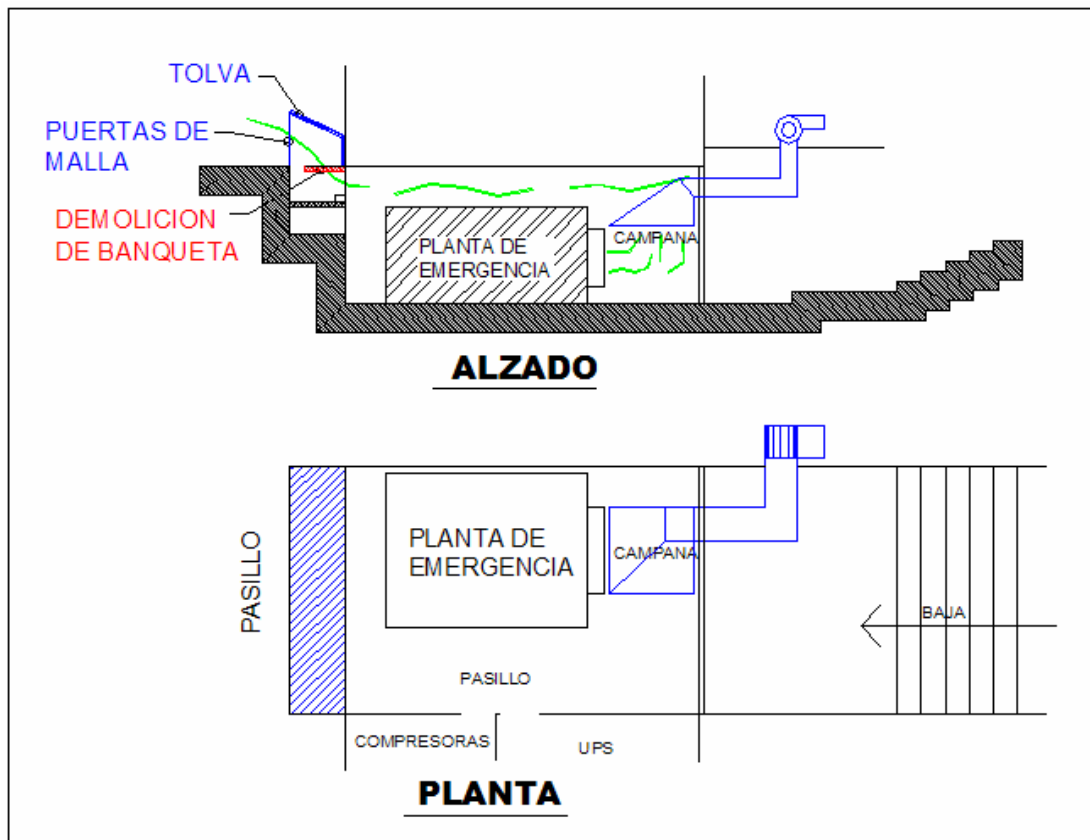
Propuesta de ventilación a planta de emergencia de 150 kW
